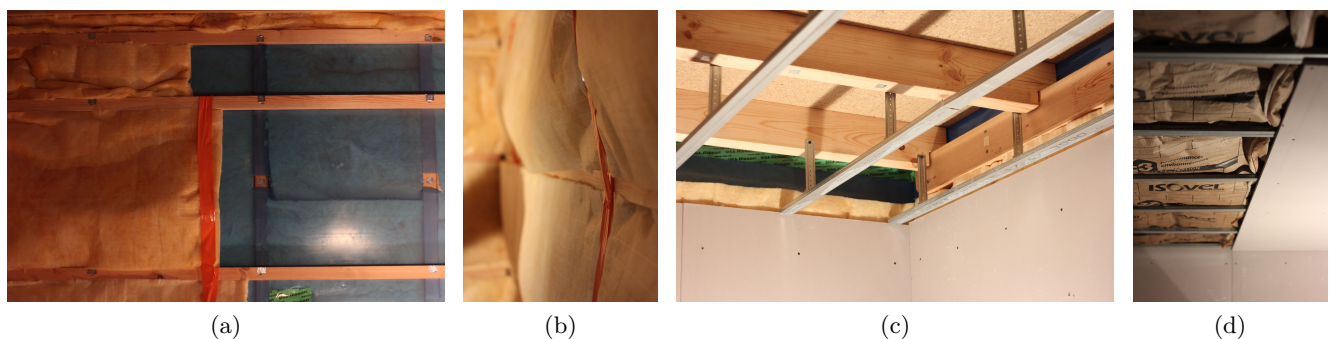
Installation du doublage des parois à l'aide de plaques de plâtre sur tasseaux.
